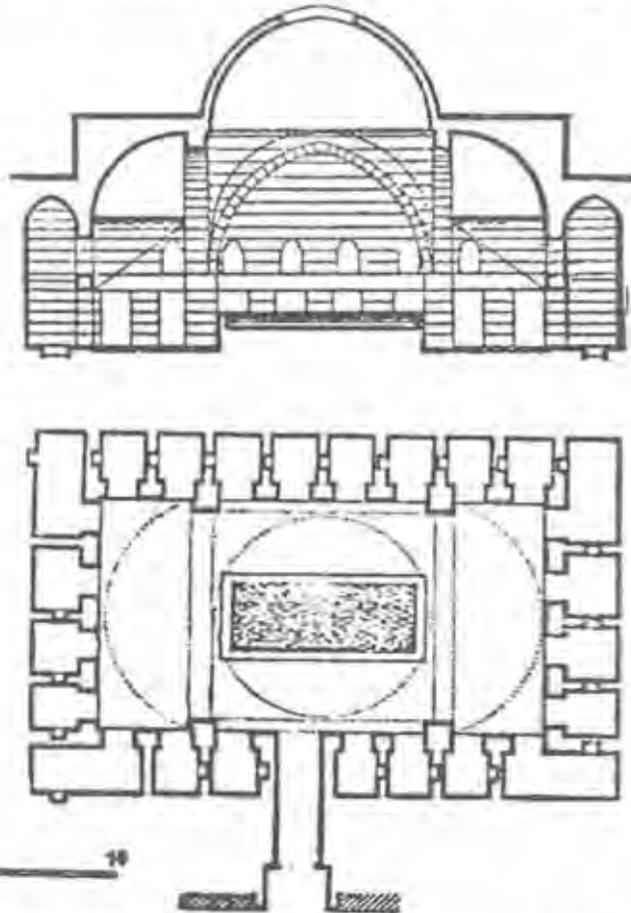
Grundriß und Schnitt im öffentliche Bedürfnisanstalt aus dem 14. Jahrhundert.³⁷
